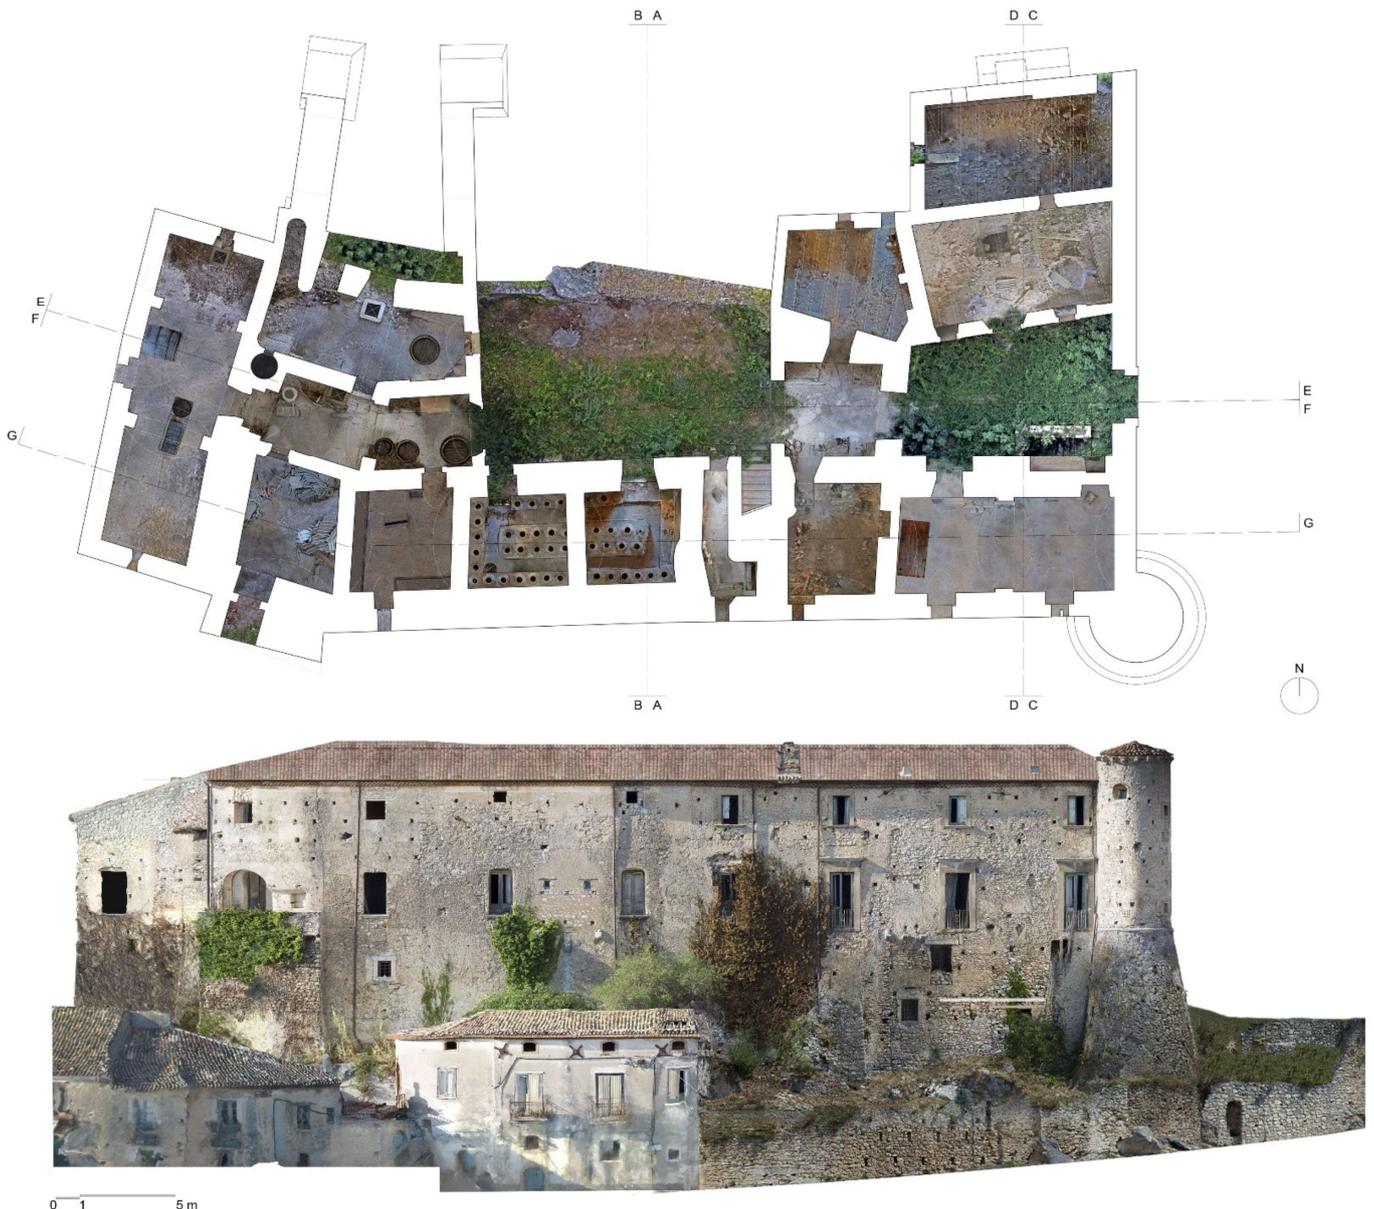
Castello di Sant'Angelo a Fasanella, pianta del piano terra e ortofoto del prospetto sud.
